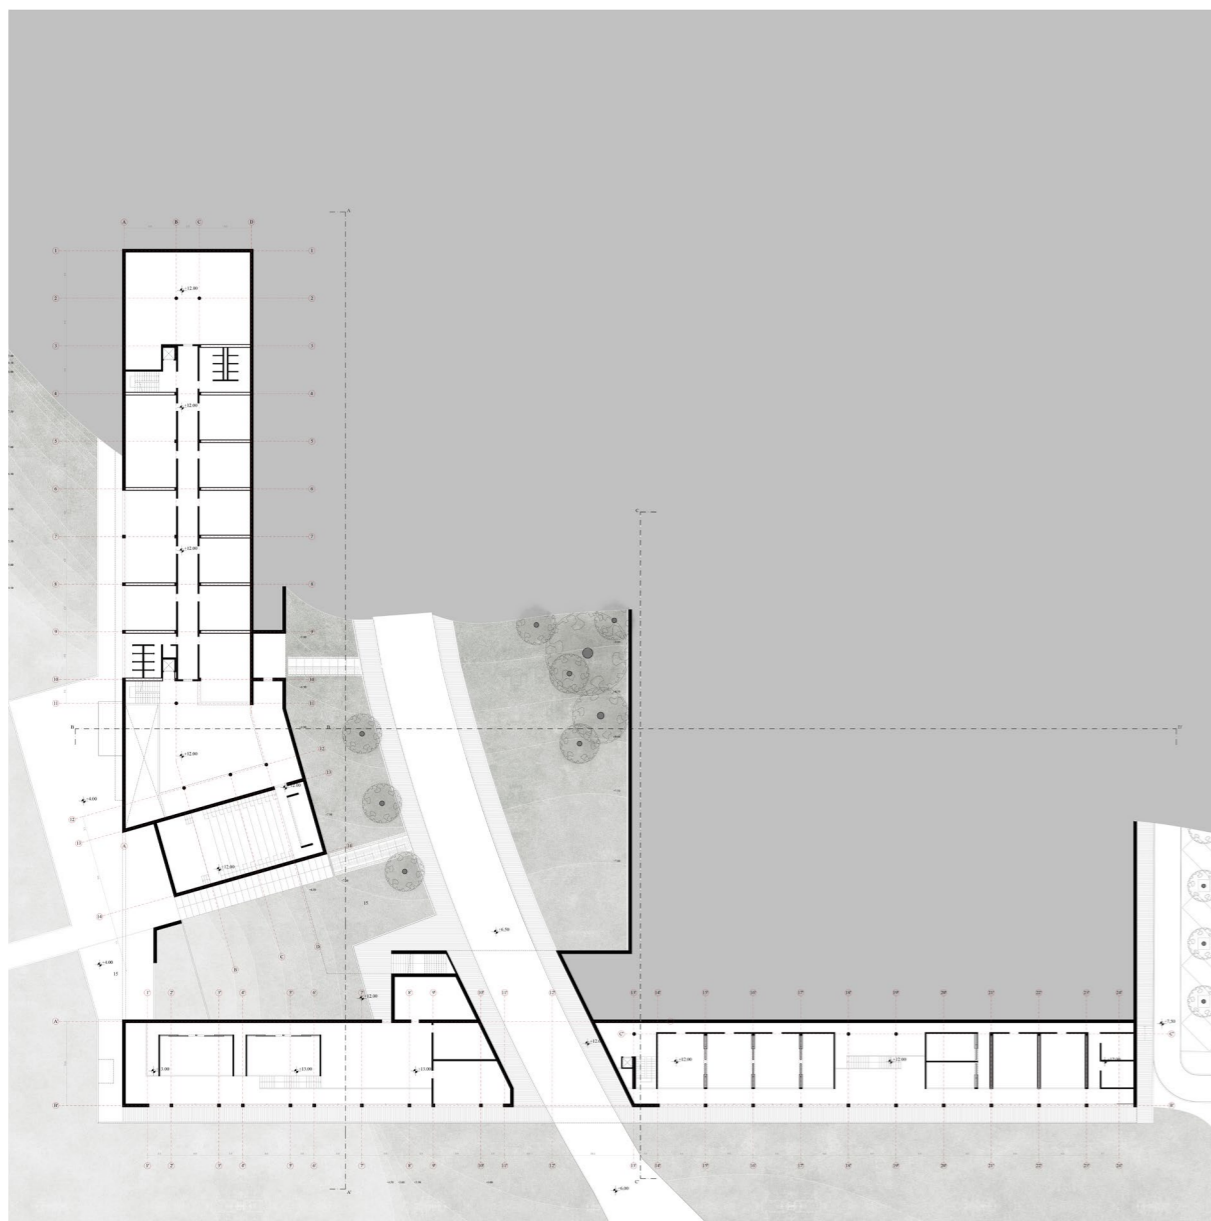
Pianta di progetto, quota di sezione +9.50 metri
